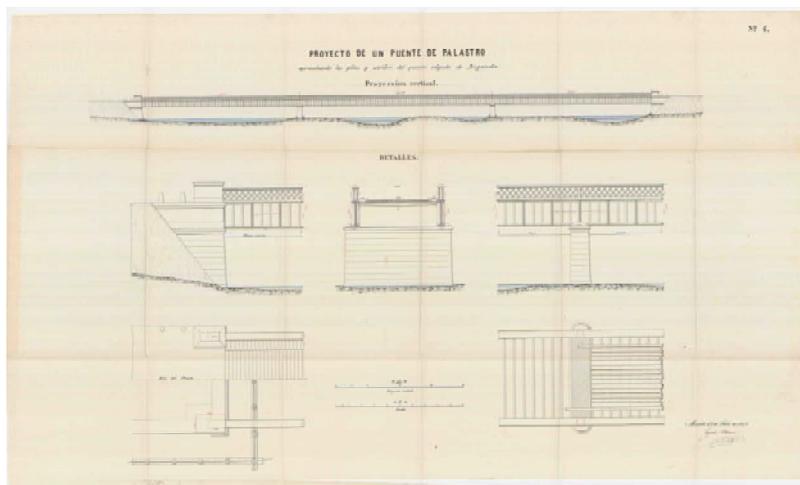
[España] Ministerio de Cultura y Deporte. Archivo General de la Administración, Signatura 24-02469, Plano nº 6 de detalles y proyección vertical del puente de palastro (Ingeniero Eugenio Barrón, Madrid, 10 de julio de 1859).
